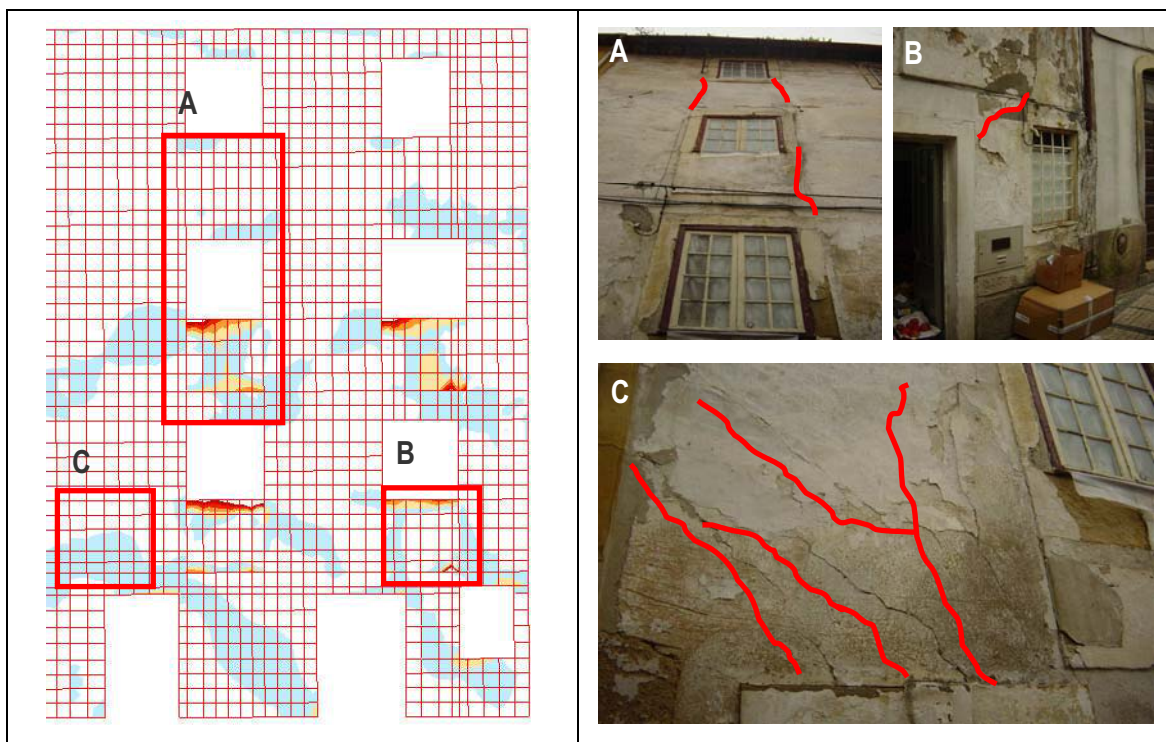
Fissuração observada e distribuição de tensões principais de tracção superiores a 50kPa para as cargas verticais
